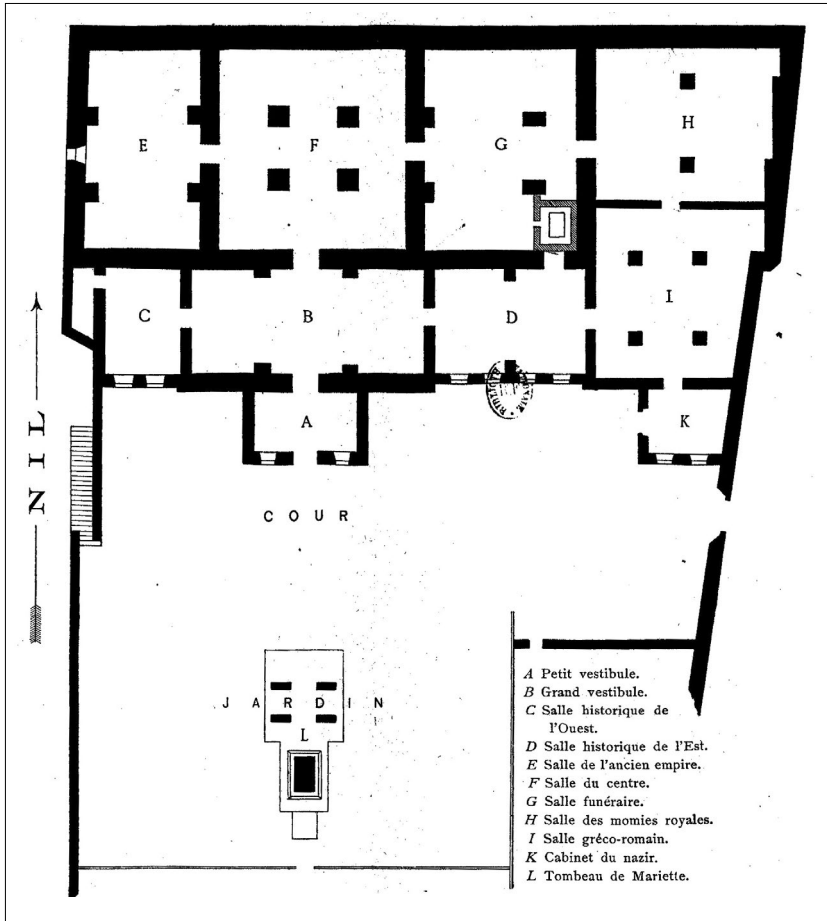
Bulaq-Museum in Kairo, Grundriss um 1883
